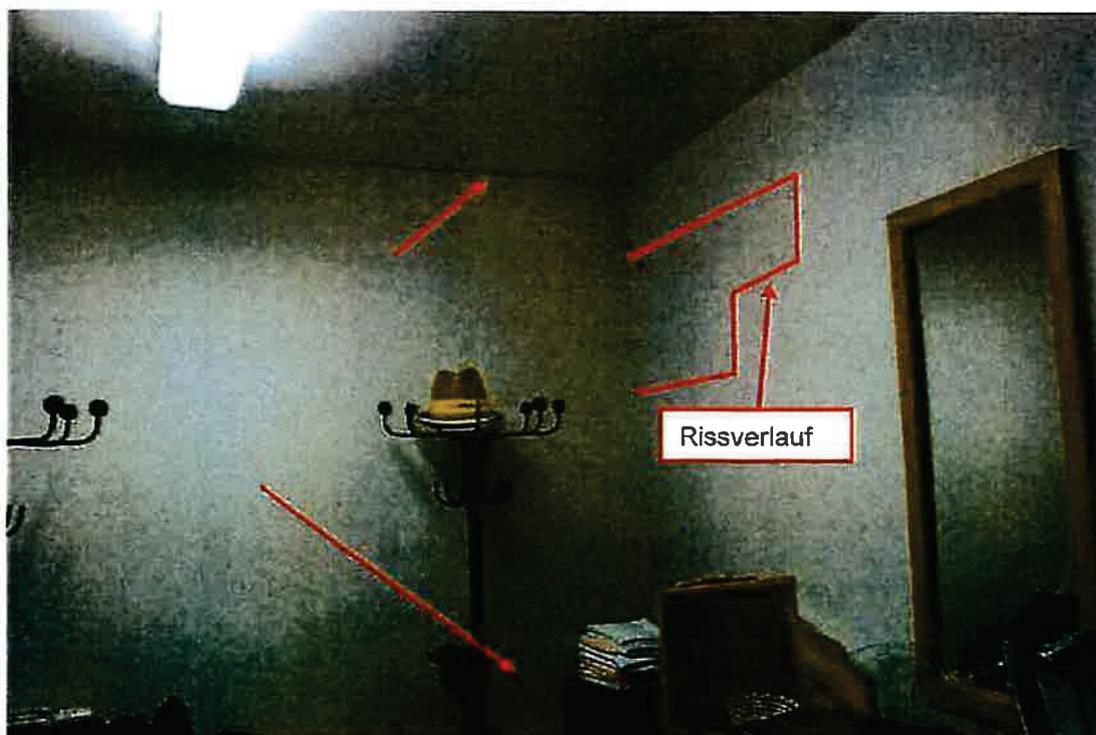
Lager 1.7 Außenwand nord und Wand zu Raum 1.8
